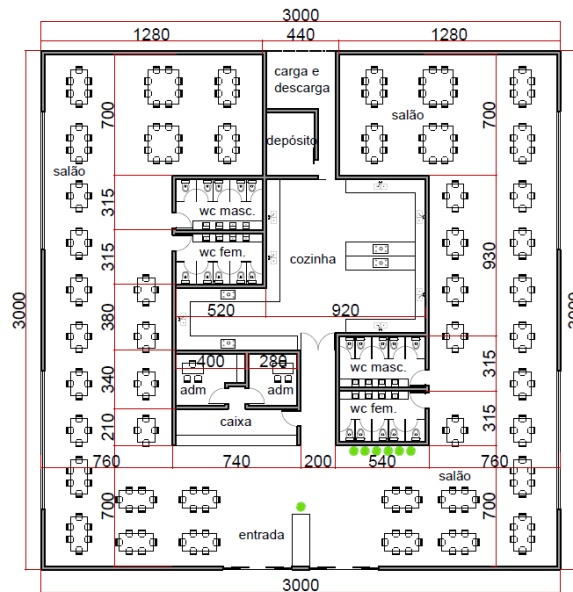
PLANTA ARQUITETÔNICA RESTAURANTE. DIMENSÕES EM CM.
